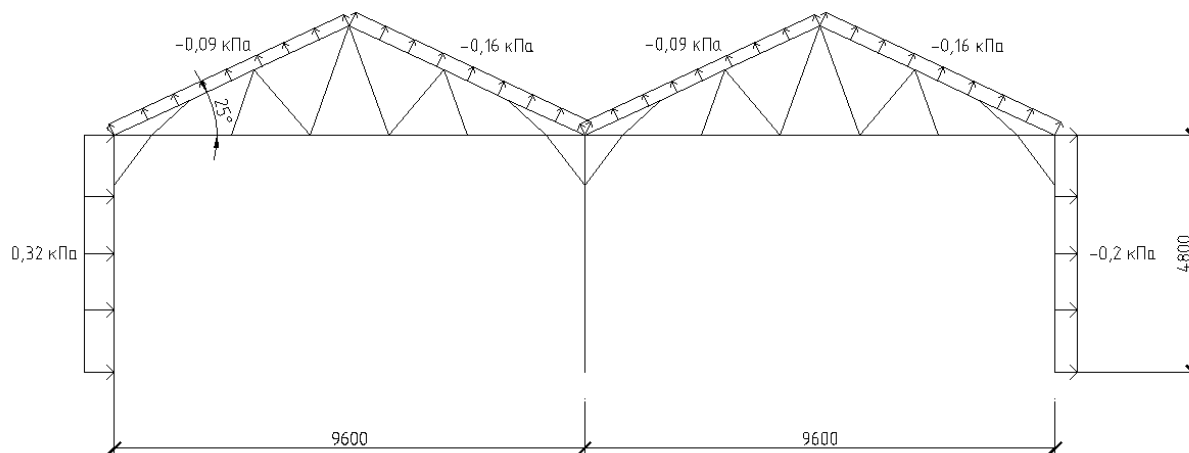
Расчетная схема для сбора ветровой нагрузки
